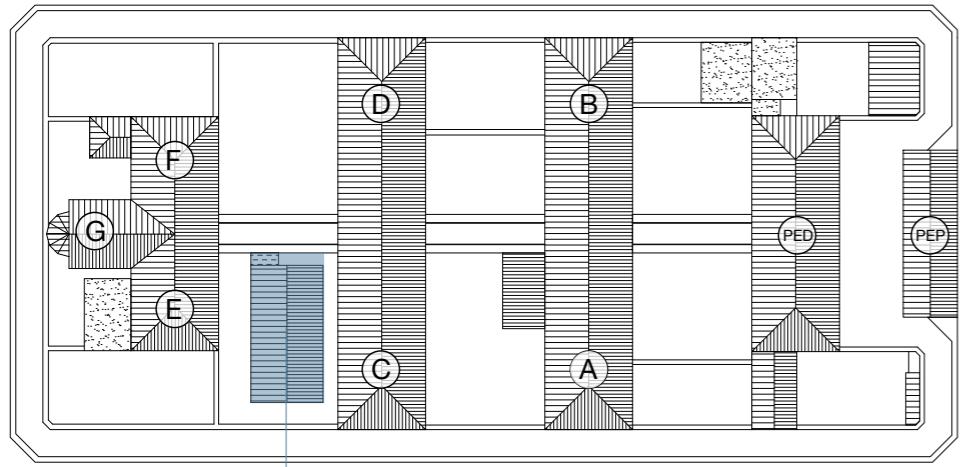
Plan de toiture supposé en 1978, d'après photographie aérienne. Source : Croisée d'archi.
